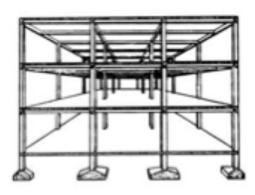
Pórtico tridimensional. (Fuente: Sistemas Estructurales 10)
